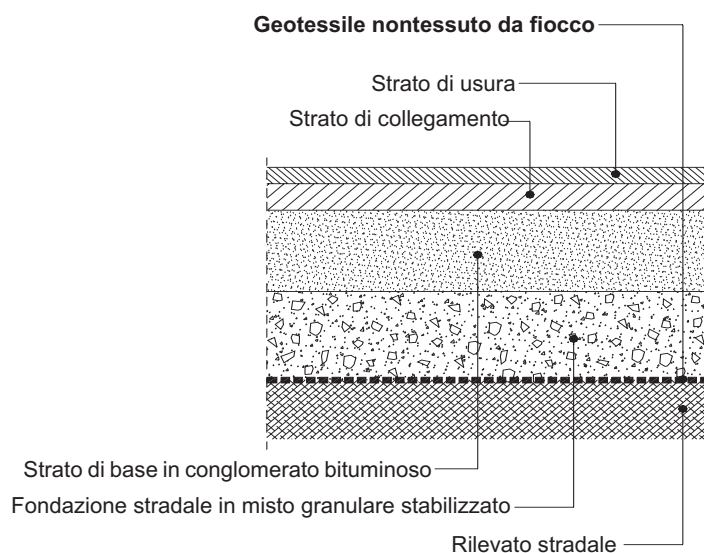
Esempio di impiego dei geotessili nontessuti da fiocco con funzione di separazione nella costruzione di strade pavimentate
